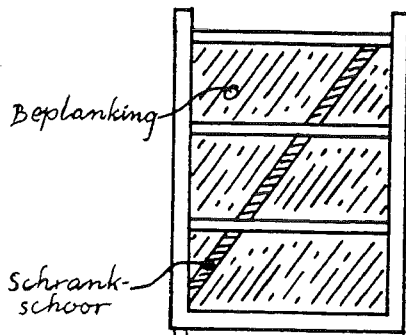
Beplanking en schrank-schoor bij een houten deur
